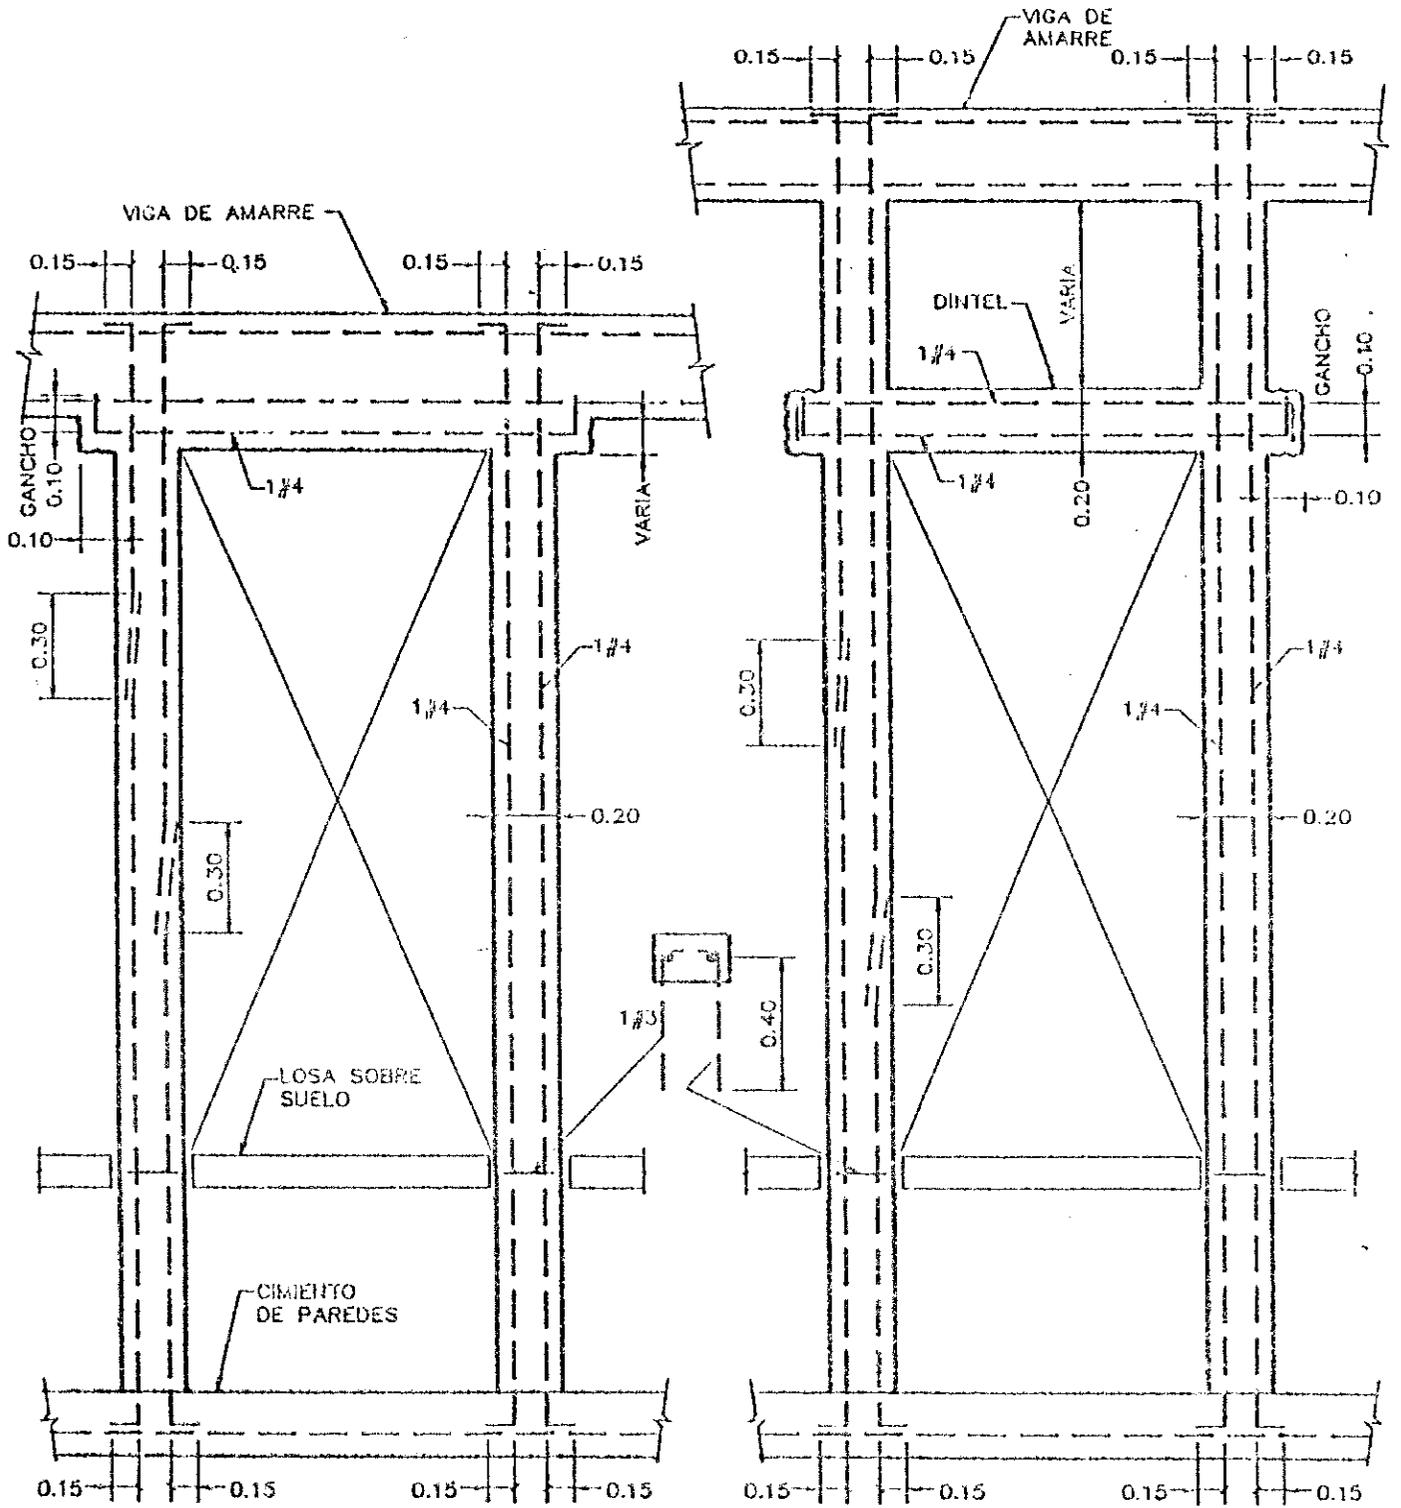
REFUERZO ALREDEDOR DE PUERTAS
